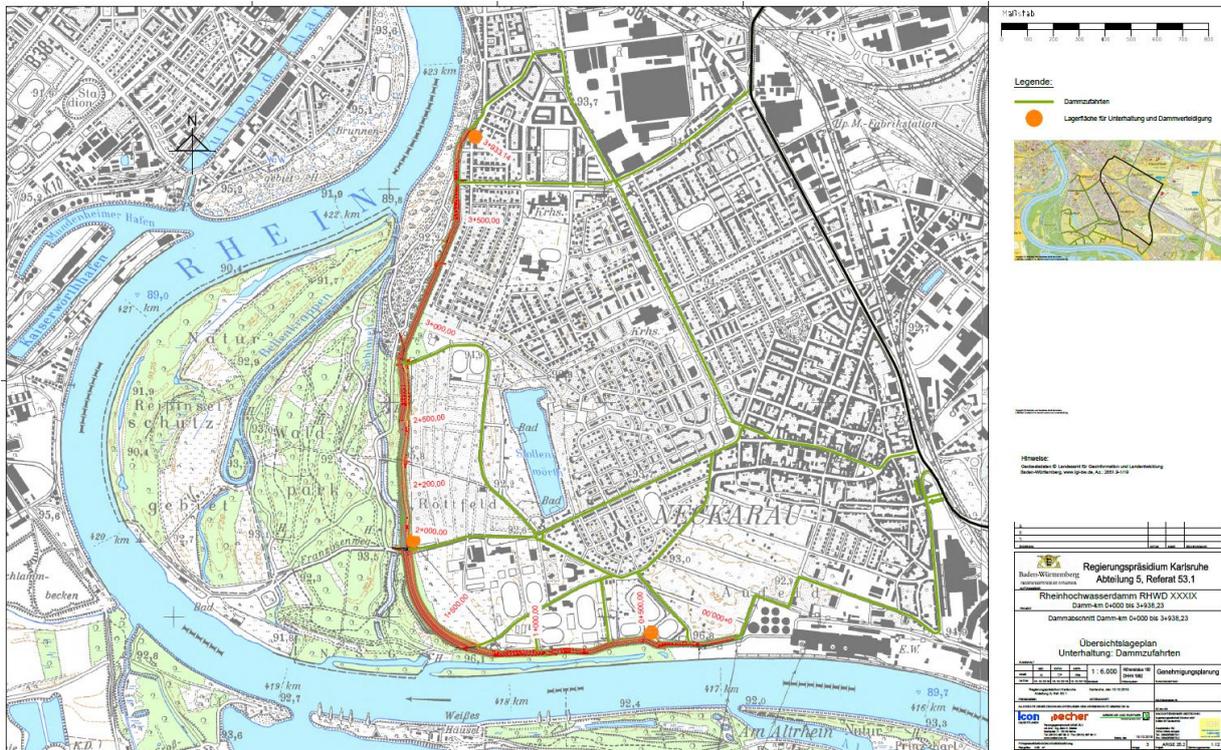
Übersichtslageplan Unterhaltung: Dammzufahrten, Plan Nr. 1.12
